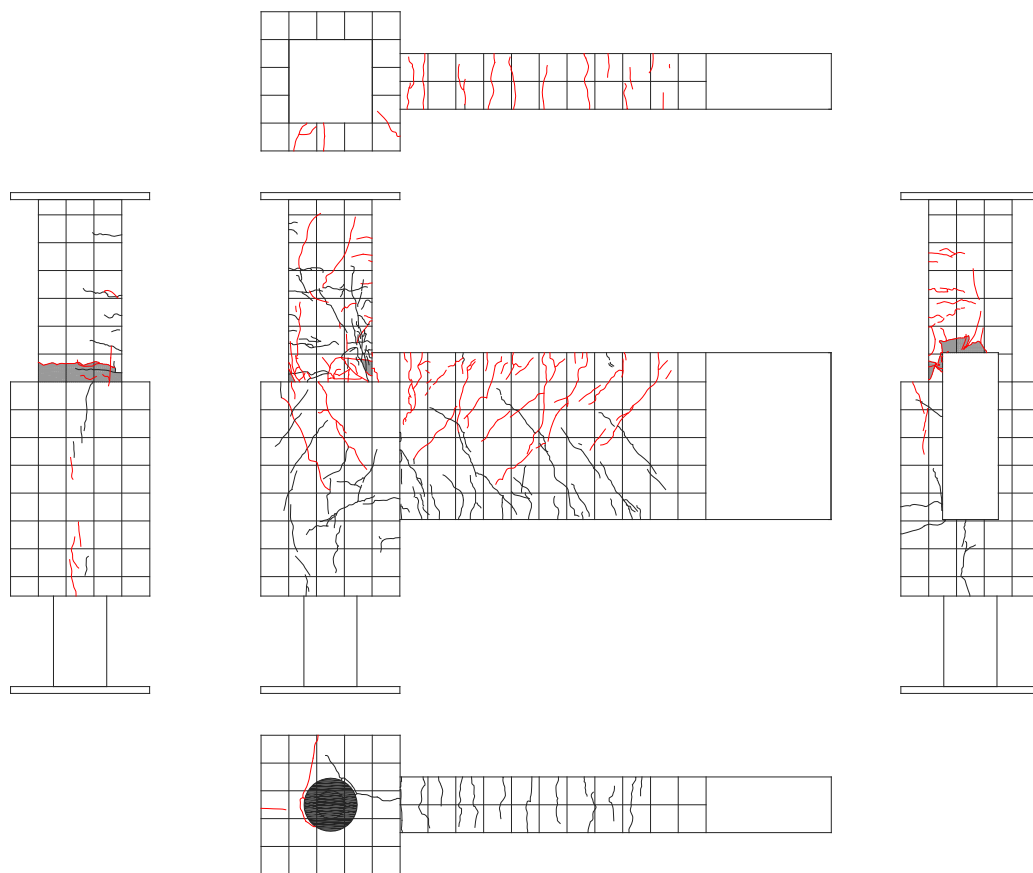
試験体 A-6 ひび割れ状況 (60cycle)
